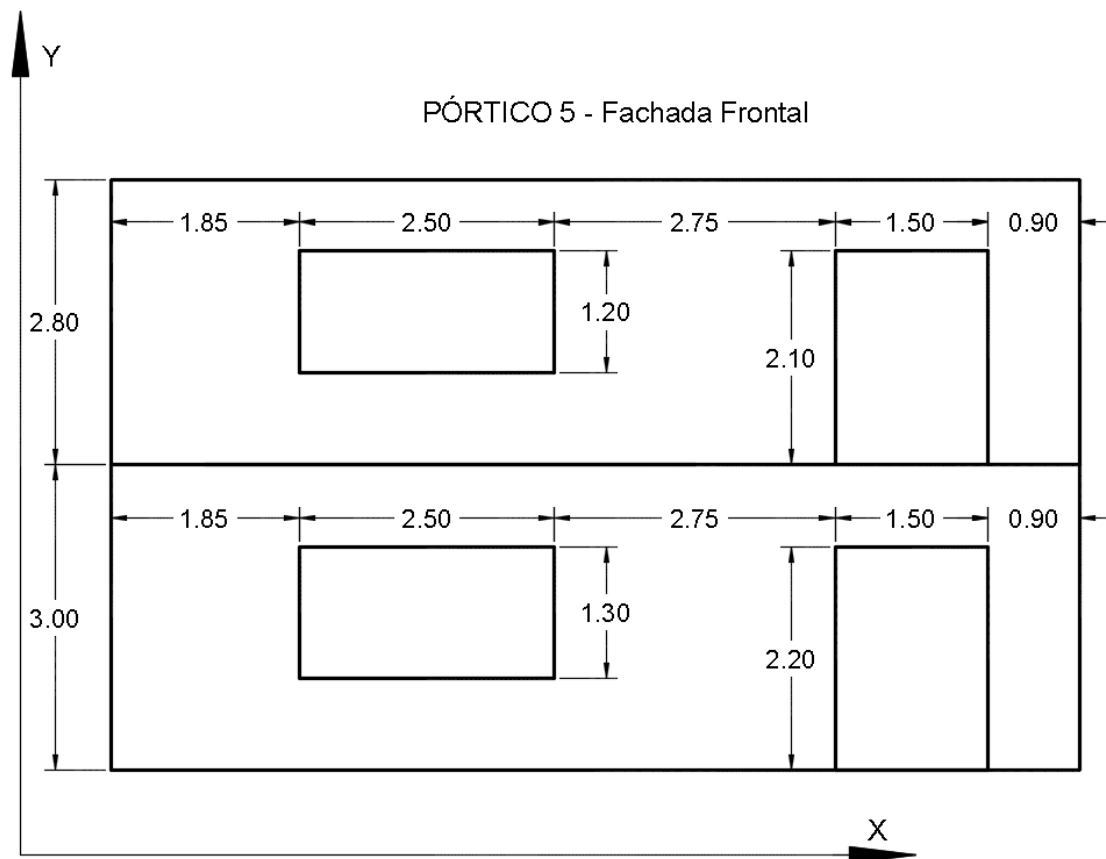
Dimensiones del Pórtico 5 (Fachada frontal).
